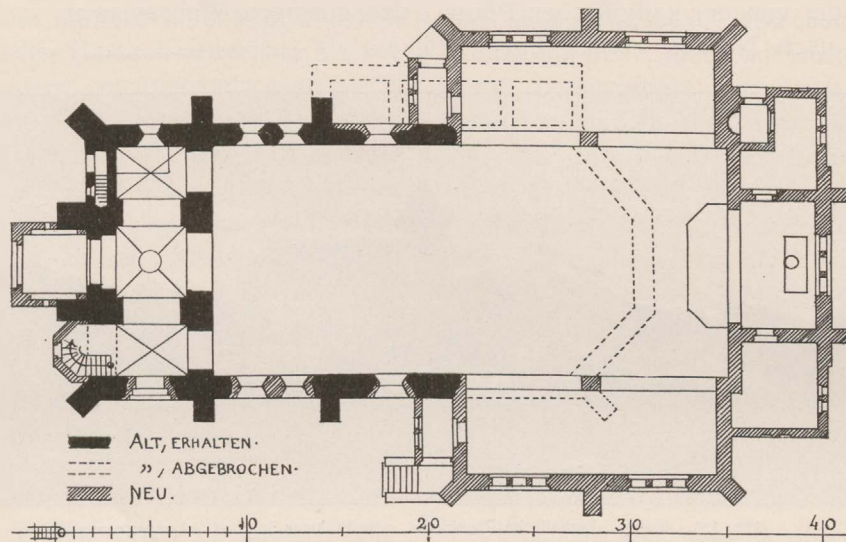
Stuhm. Grundriß der kath. Pfarrkirche nach dem Erweiterungsbau.
